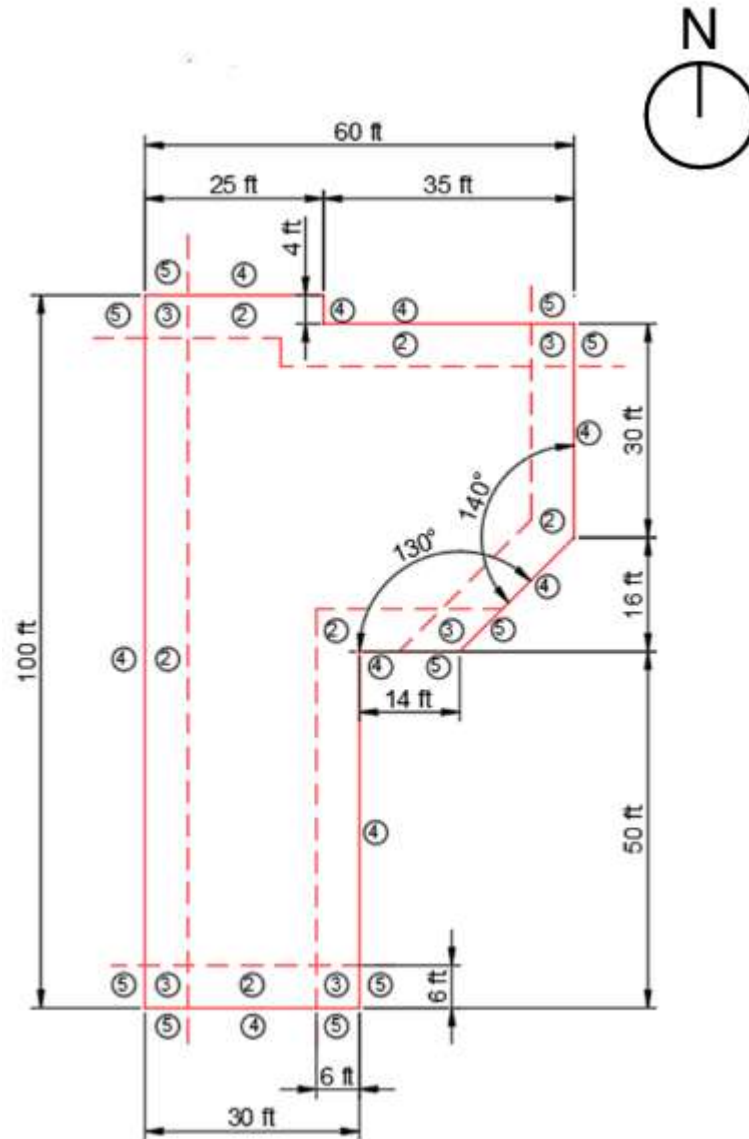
Vista en planta de la edificación con sus respectivas zonas de viento para muros y techos según ASCE 7-22
